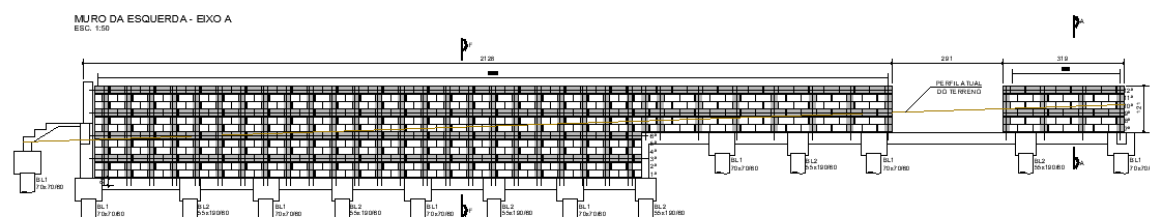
Conceção estrutural – muro da esquerda (cm).
